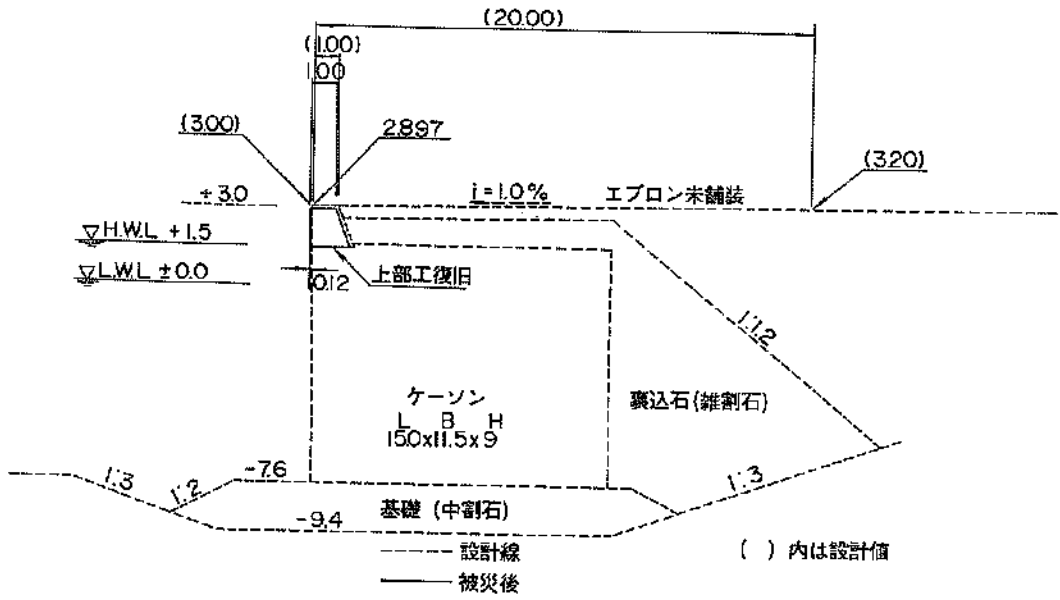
標準断面図・被災変形図 (第3埠頭地区, ③東側岸壁(-7.5m))
